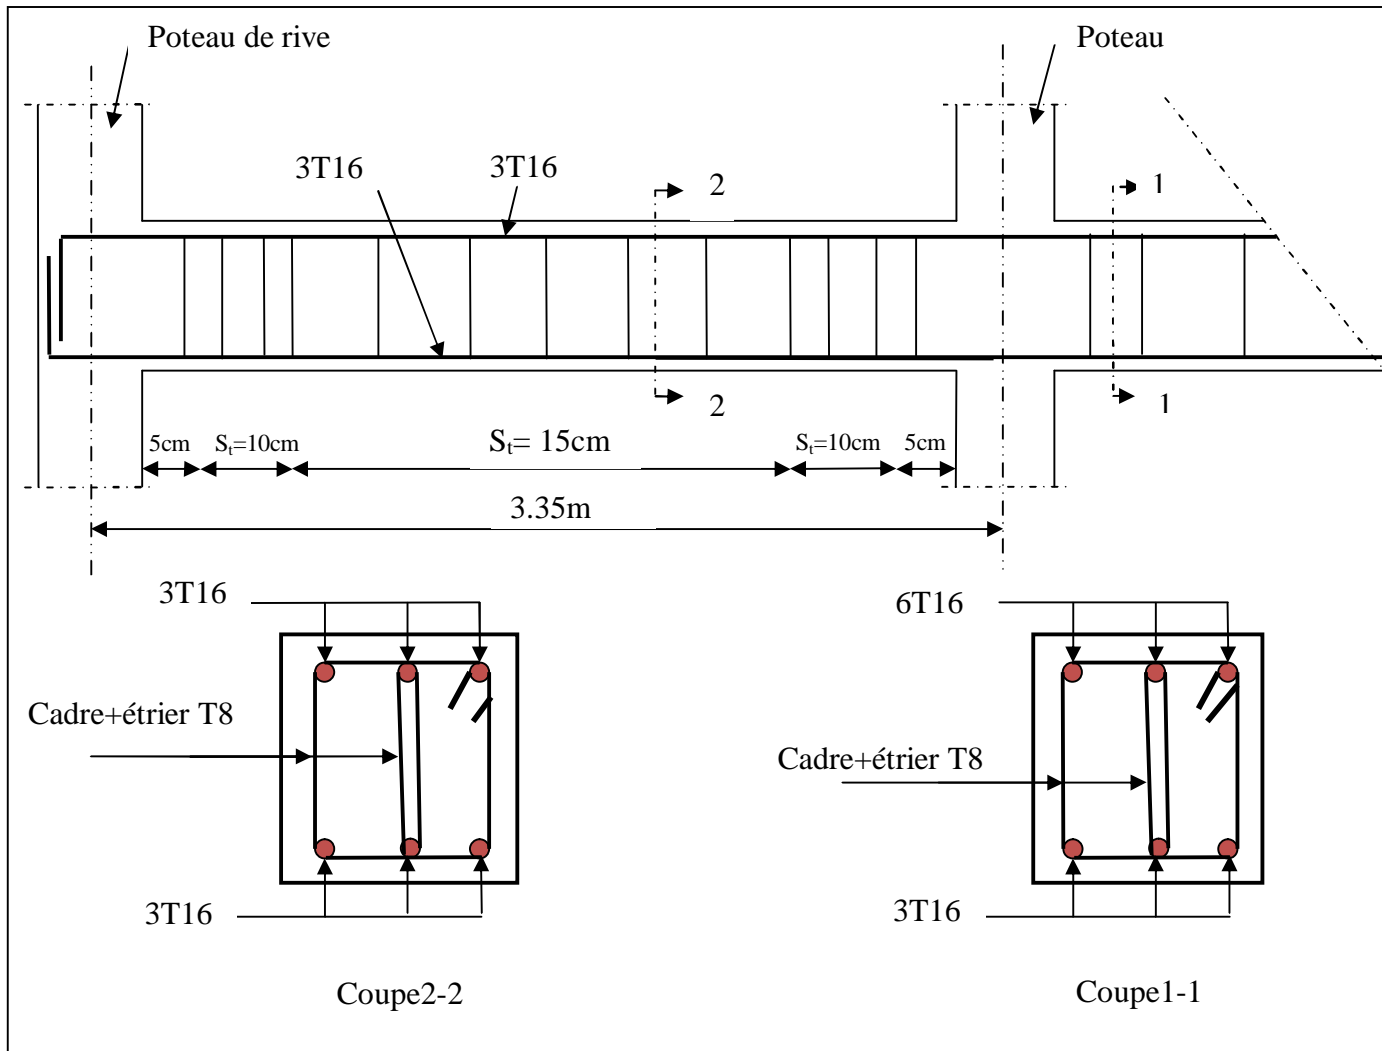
Schéma de ferrailage des poutres secondaires (étage courant)
